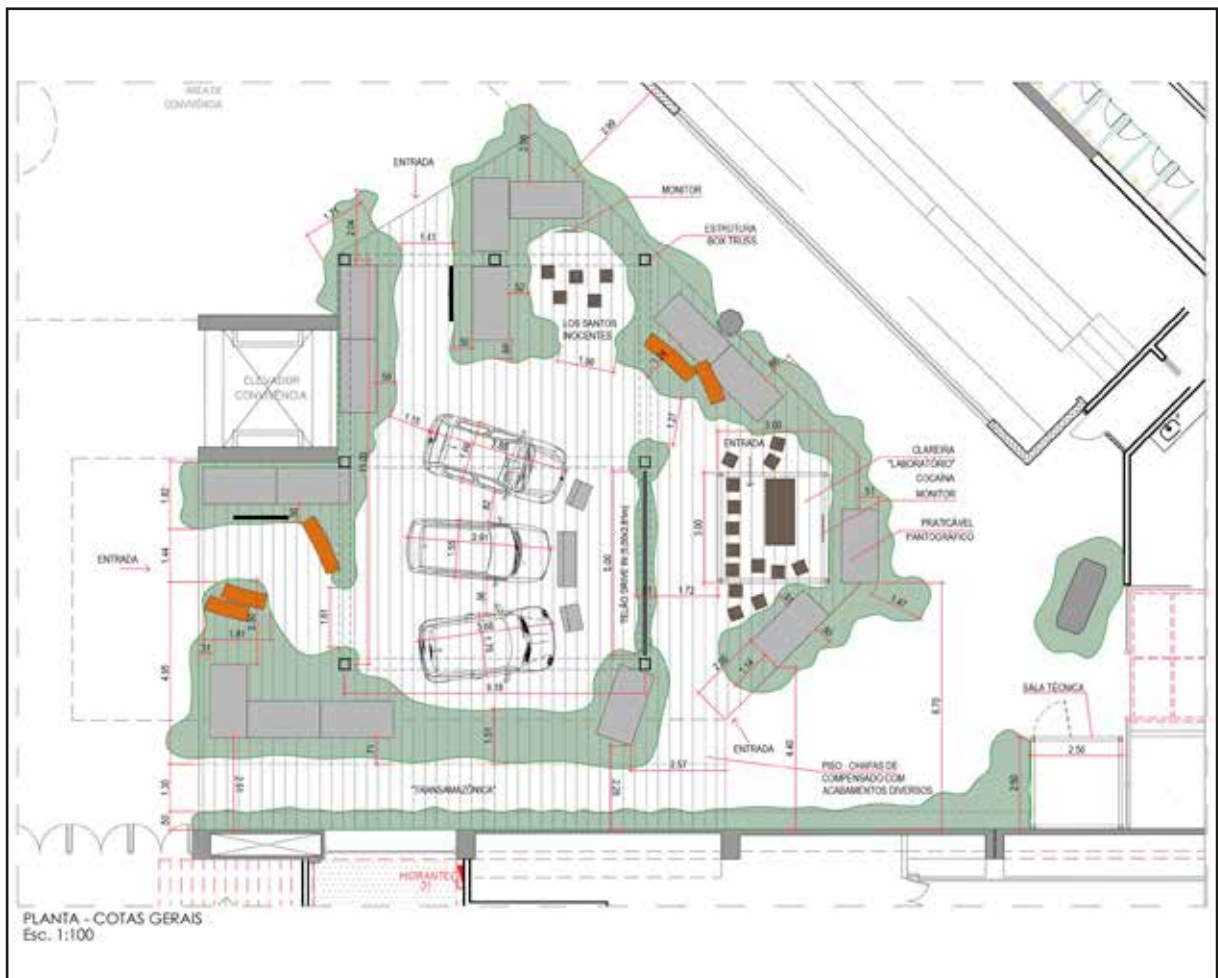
Planta final da instalação com distribuição dos espaços. Desenho de Aline Arroyo.
